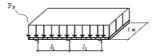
Расчётная схема для определения погонной нагрузки q
